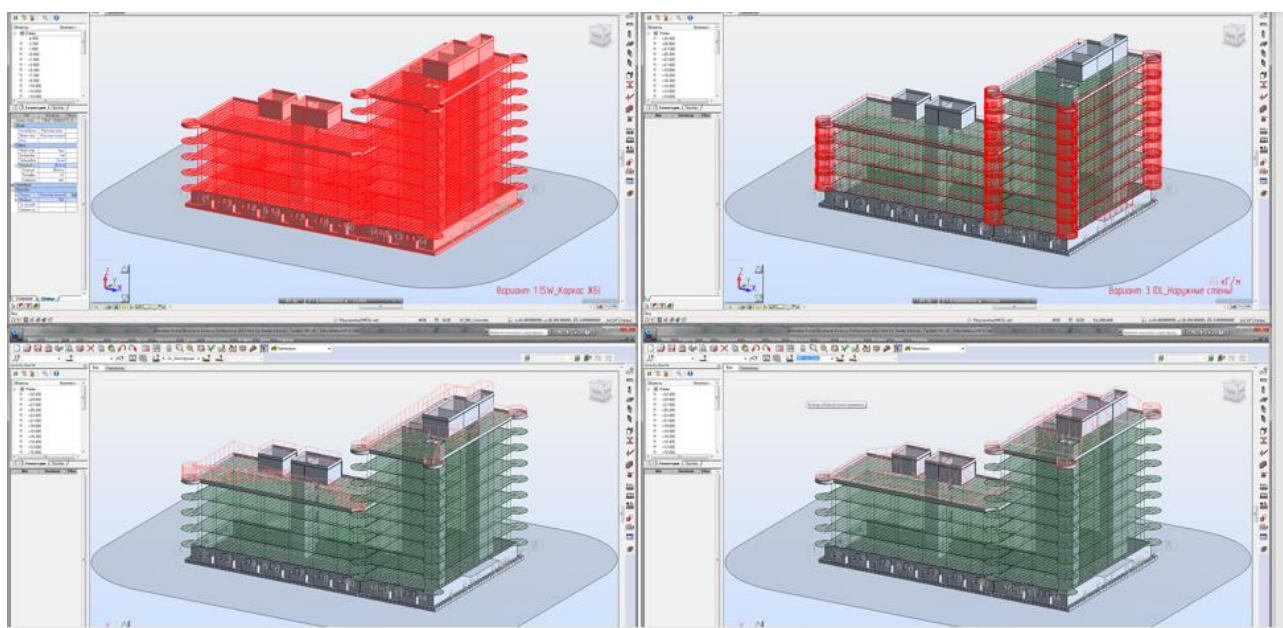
Кінцвоелементна модель залізобетонної монолітної будівлі в RSA [8,9]
